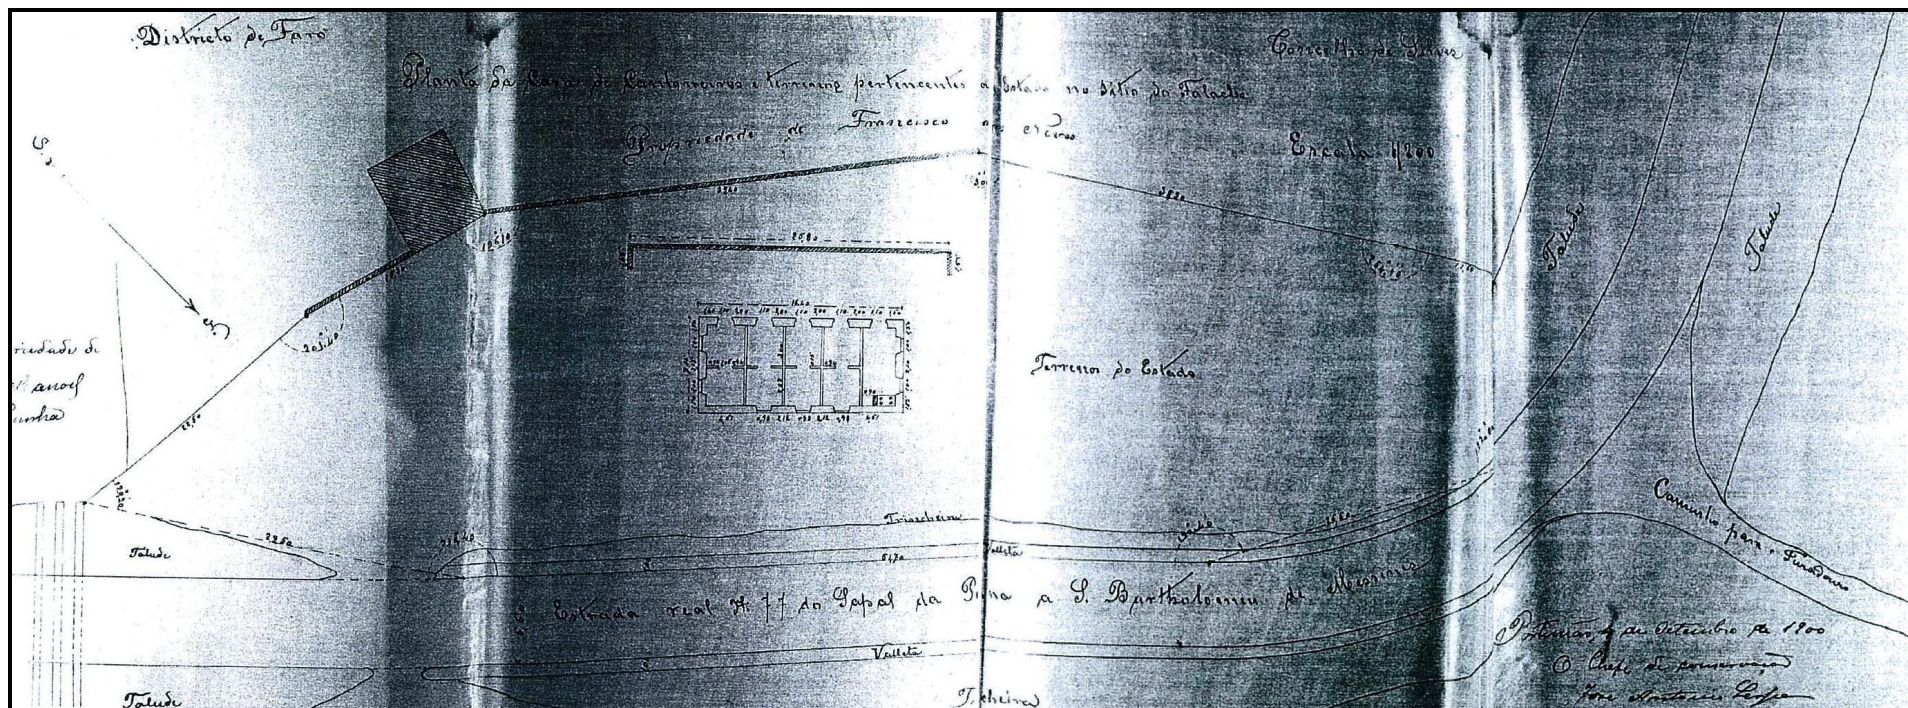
Planta da casa de cantoneiros e terrenos pertencentes ao Estado no sitio do Falacho. 1900.
